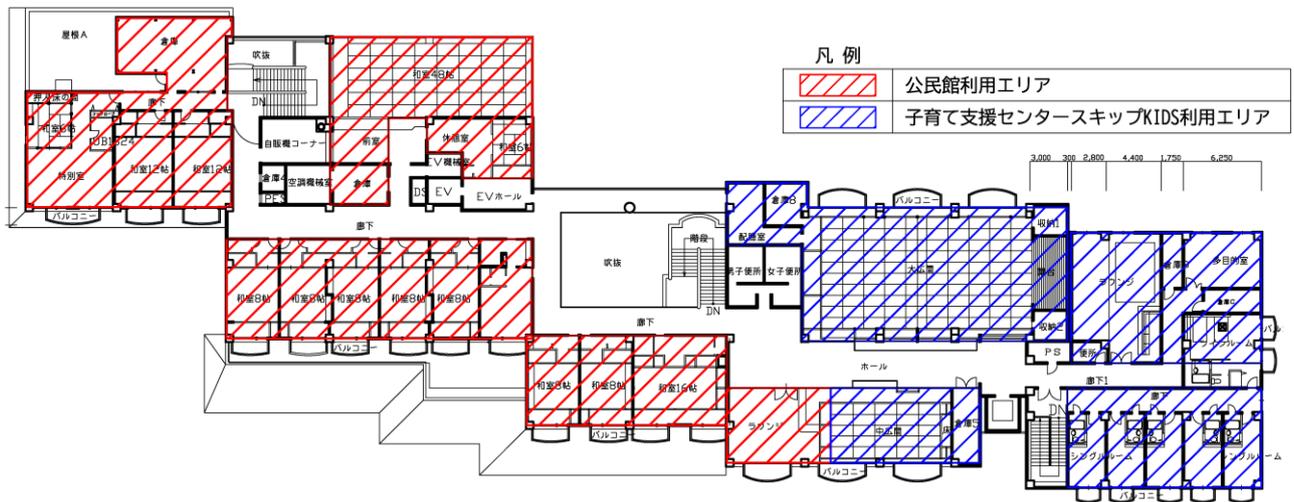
サンヒル柏原 機能位置図 (案) 2階平面図
